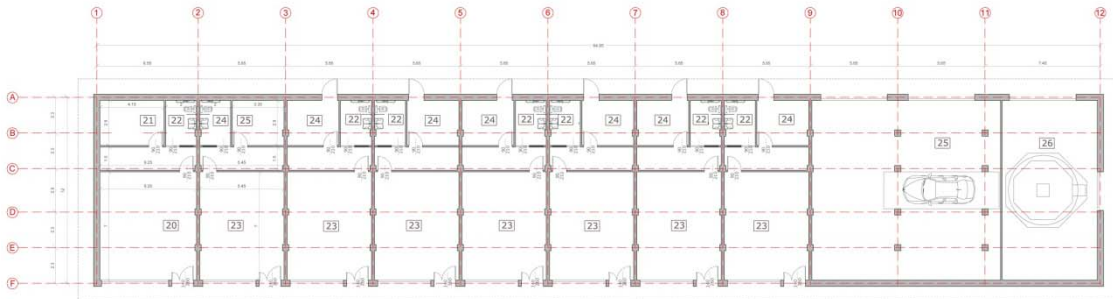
Pianta piano terra commerciale dell'edificio parcheggio, stralcio della tavola 5.17, *Piante centro sportivo e parcheggio*. Fonte. Elaborazione grafica dell'autore.
